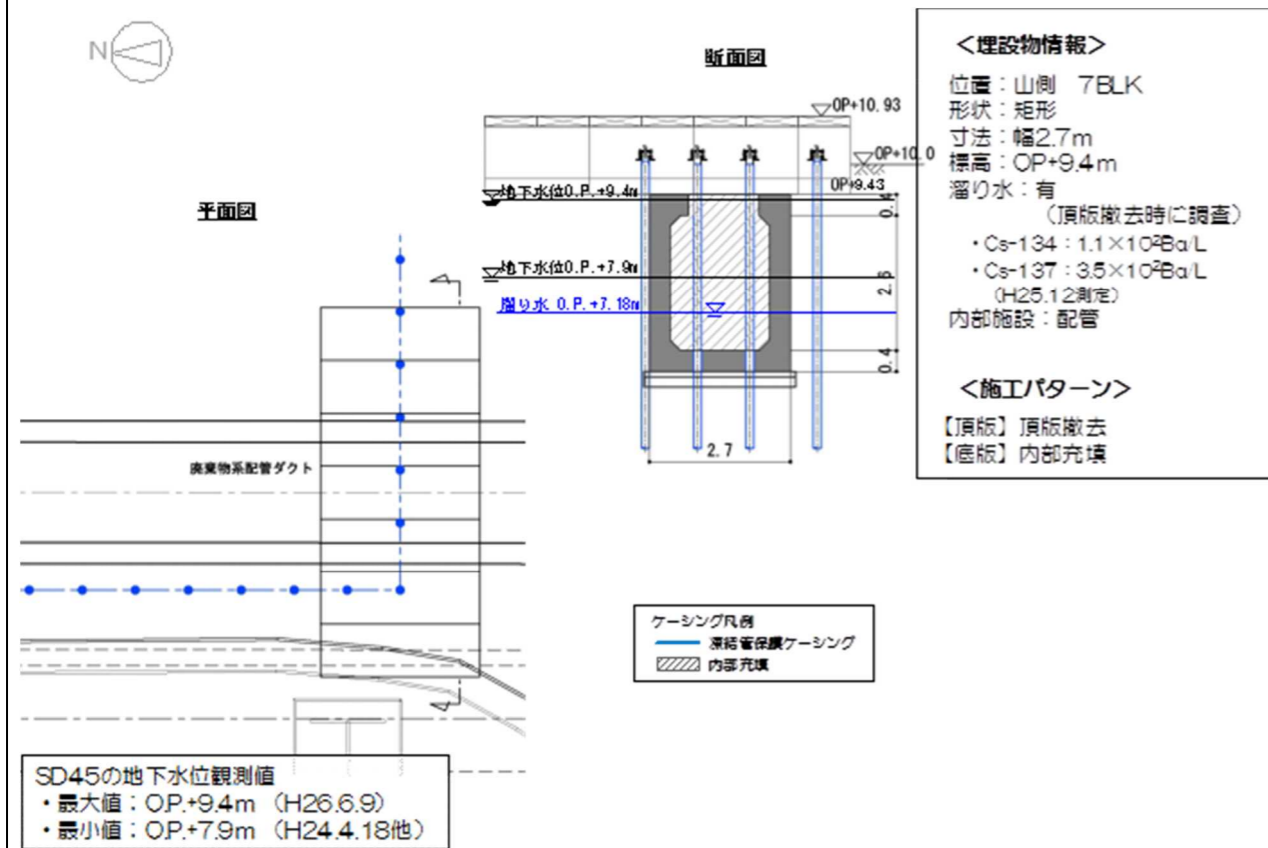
【7-4】廃棄物系共通配管ダクト① 施工方法 (貫通施工)
